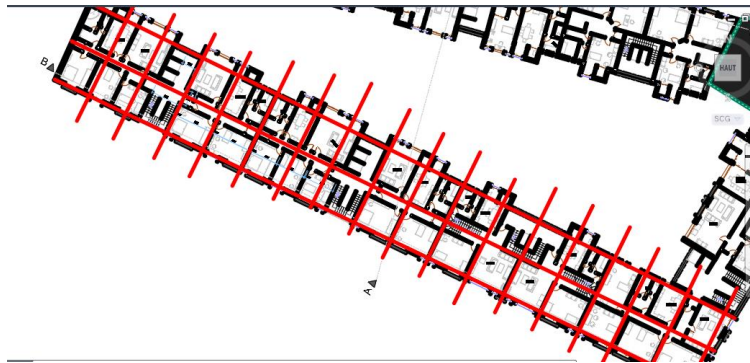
partie de la façade principale sud sur l'avenu Ali Mechkal
